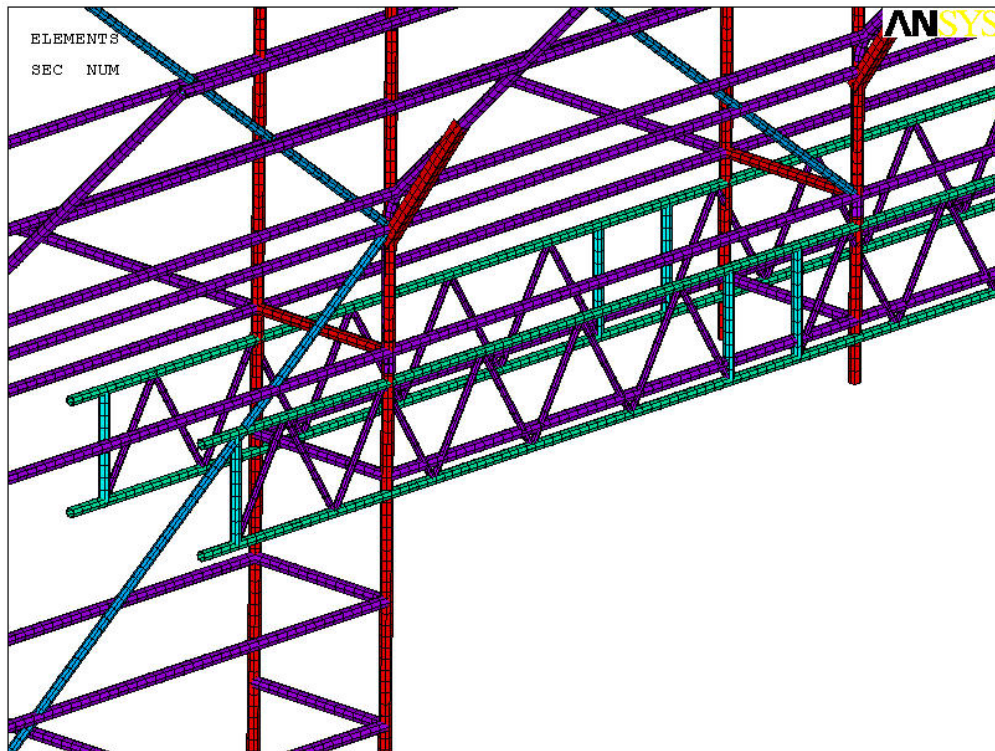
Configuración tipo 2. Detalle de las vigas celosía. Secciones por colores.
